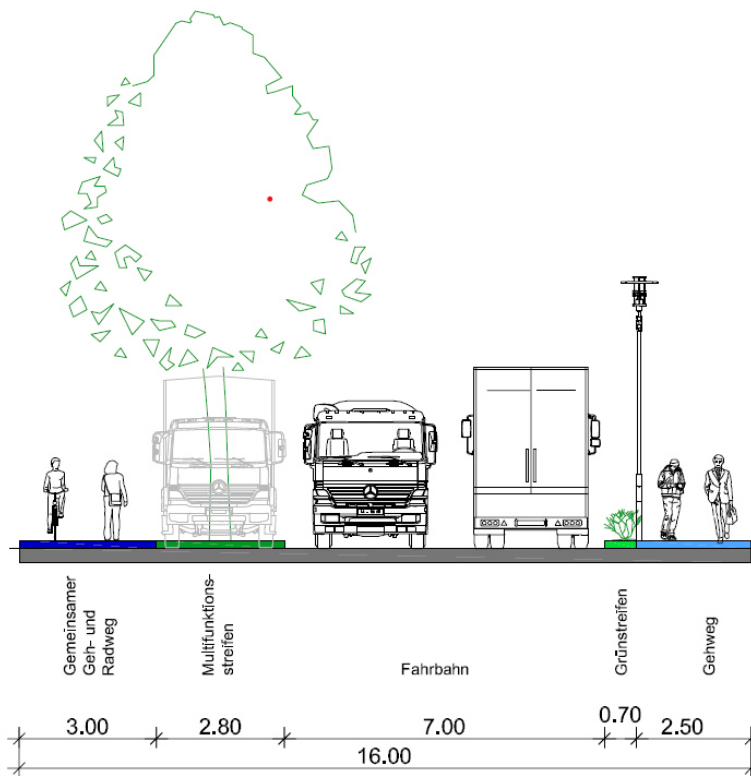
Exemplarischer Straßenquerschnitt der Planstraße mit Multifunktionsstreifen (vgl. Plan Nr. 4.2, Planungsbüro Karin Weber)
